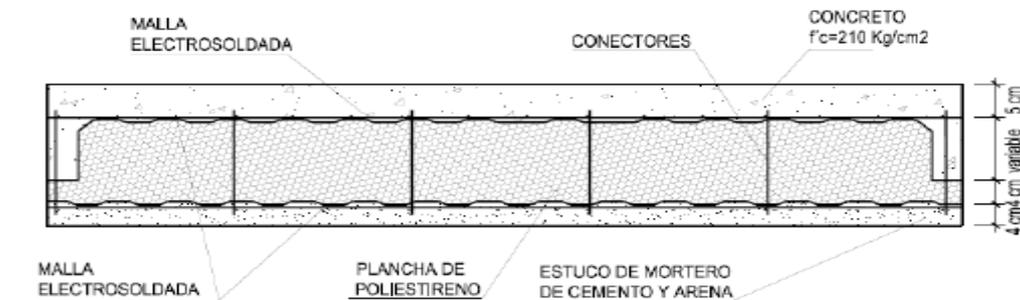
SECCIÓN TÍPICA PANEL LOSA ESTRUCTURAL PL1
